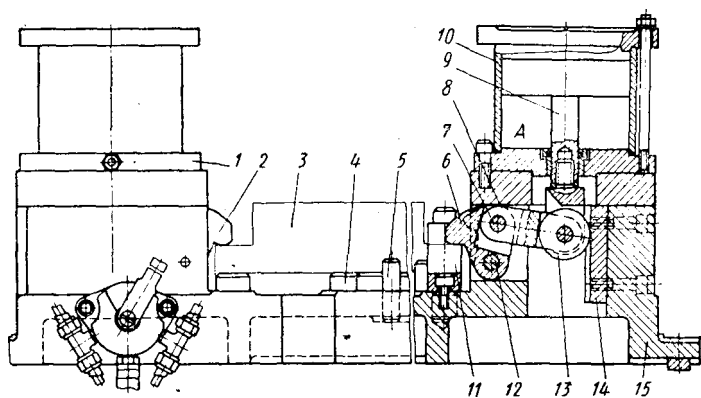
Фрезерное приспособление с рычажным усилителем зажима
